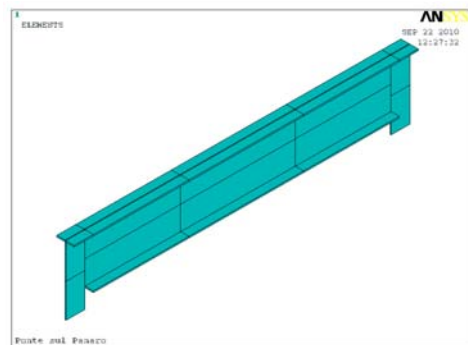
Ponte sul Panaro: vista locale degli elementi rappresentanti la trave longitudinale secondaria
